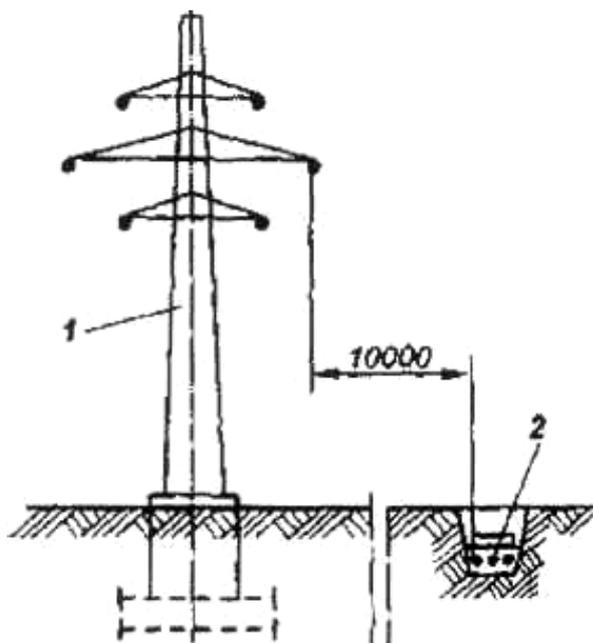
Прокладка кабелей рядом с воздушной линией электропередачи напряжением 110 кВ:
